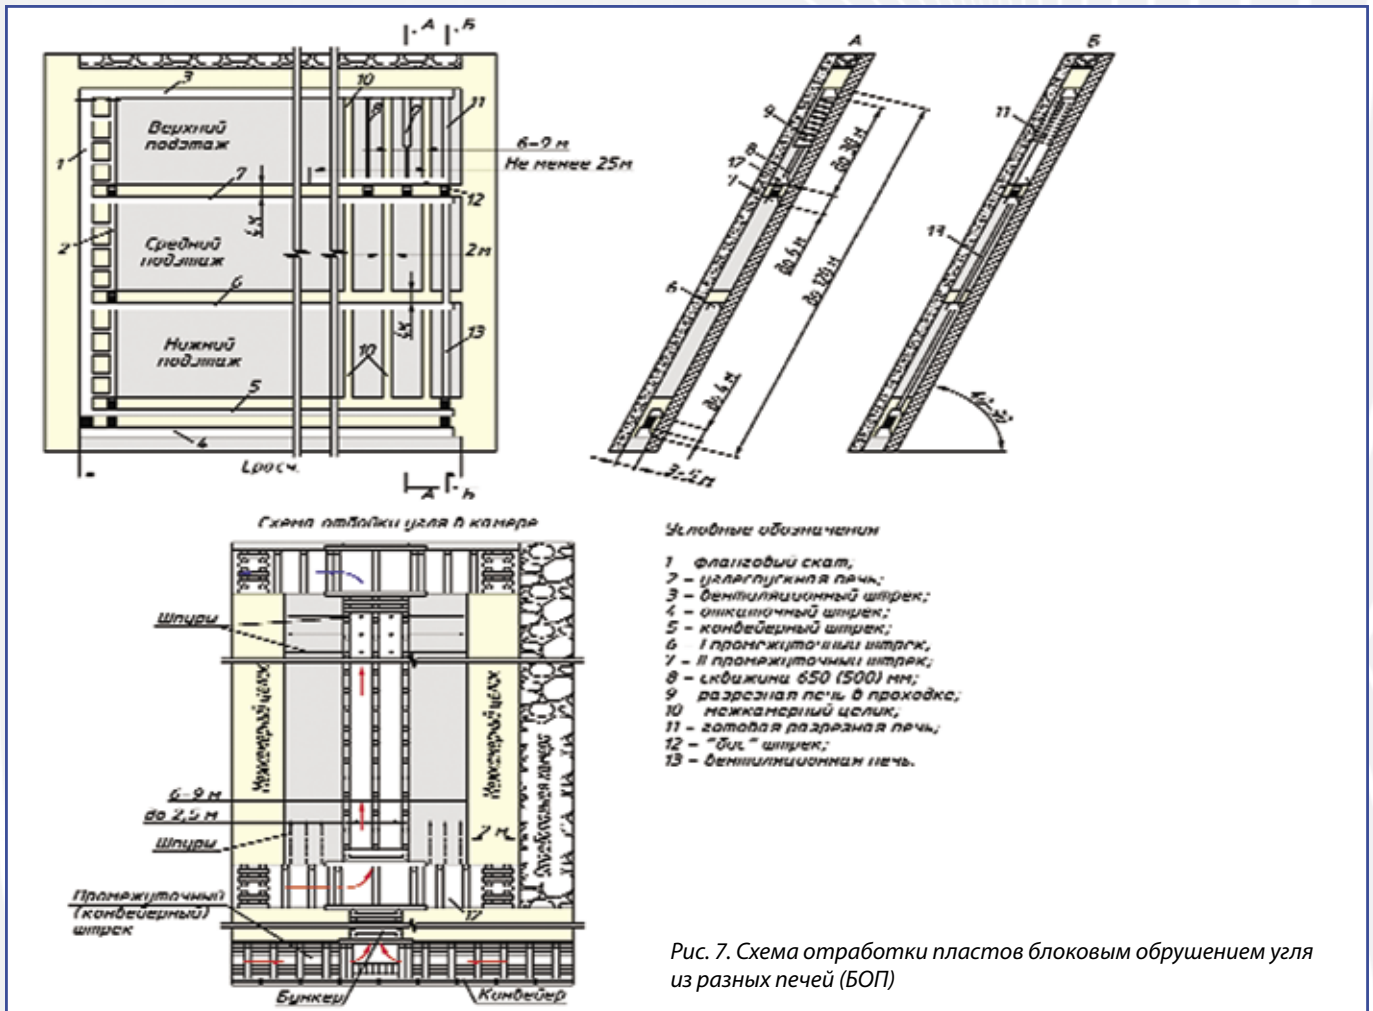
Схема отработки пластов блоковым обрушением угля из разных печей (БОП)
